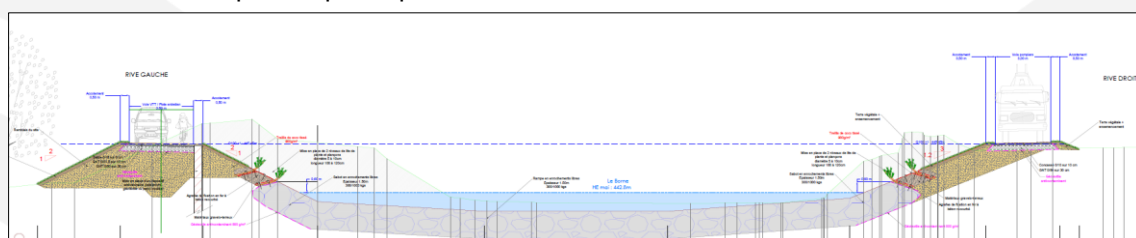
Profil en travers au droit de la double rampe (rampe aval) - PM373
